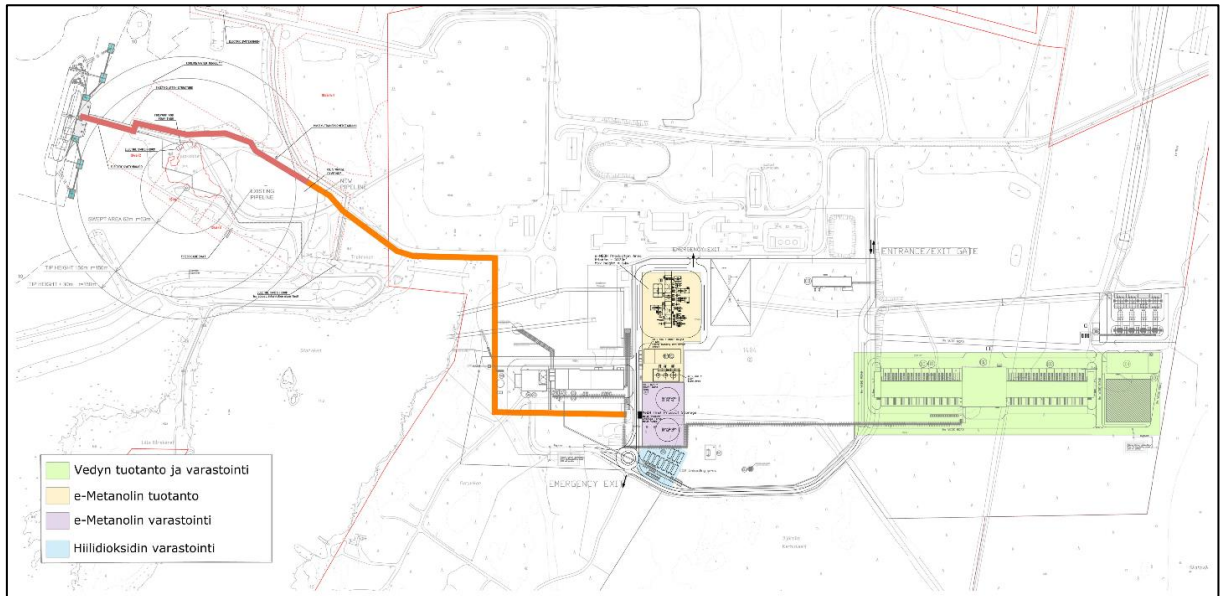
Planritning över placeringen av anläggningsenheter och -konstruktioner på anläggningsområdet, enligt alternativ ALT2. Även överföringsröret till kajen i hamnen visas (i orange) på bilden.
